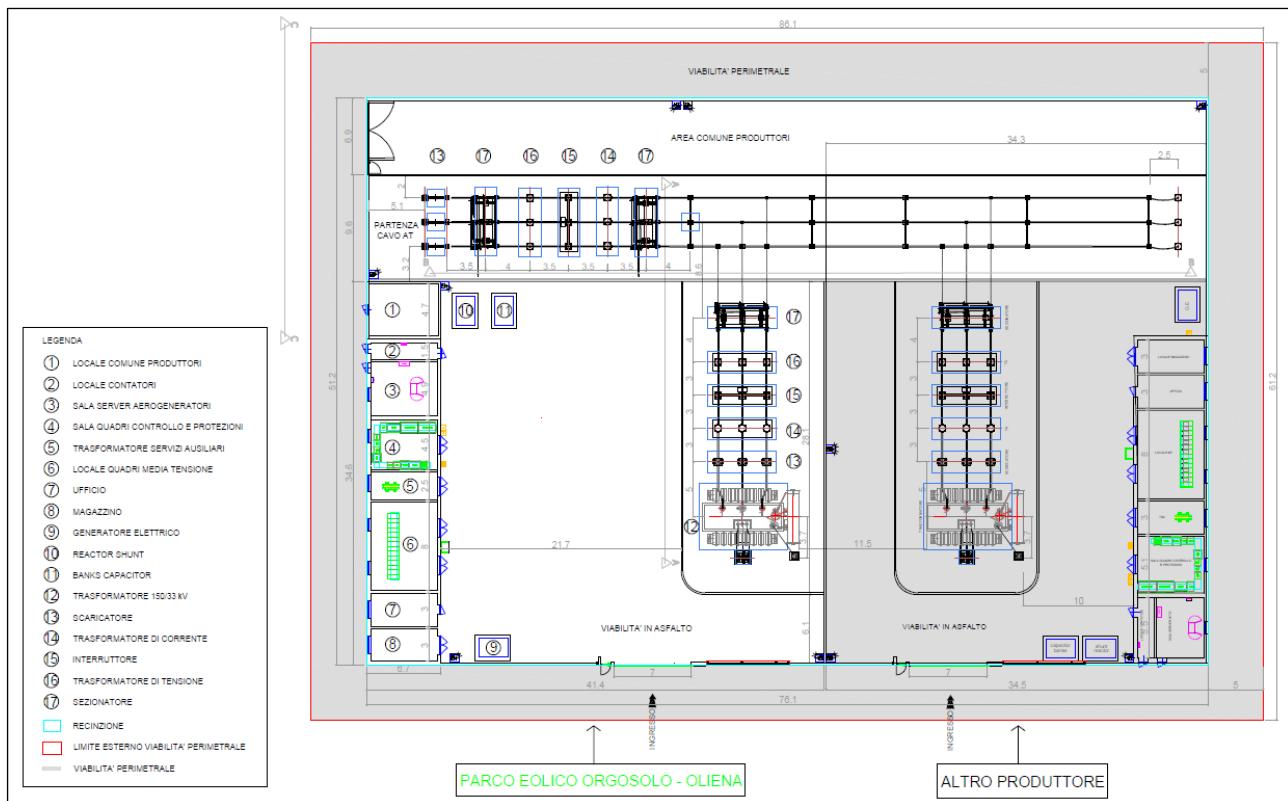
Planimetria elettromeccanica della SEU 150/33 kV
